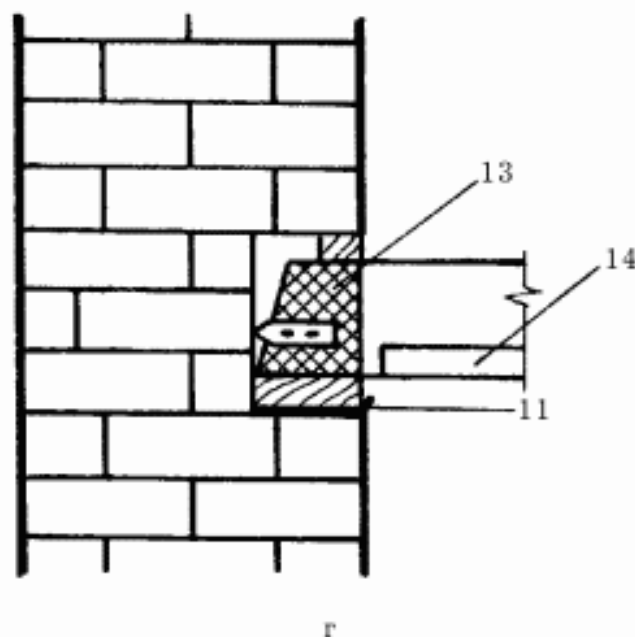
(продолжение). Конструктивные решения сплошных стен: г – опирание балки на стену; 11 – подкладка; 13 – заделываемый наглухо конец балки; 14 – черепной брусок.
